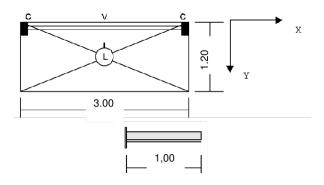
Planta de la columna correspondiente al ejercicio 2)
